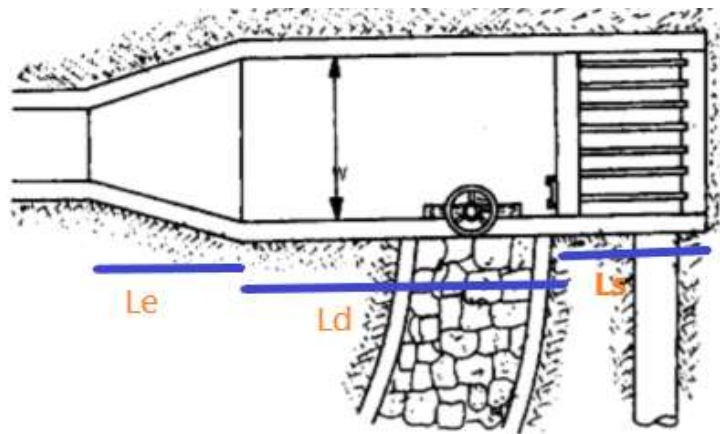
Vista de Planta del Desarenador y Cámara de Carga.
